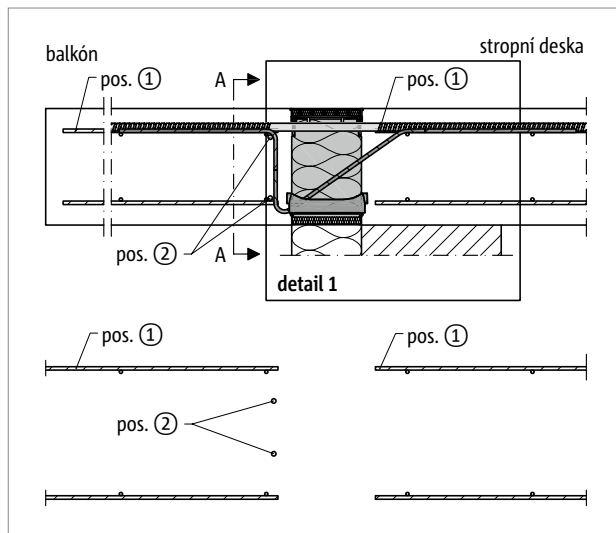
Schöck Isokorb® CXT typ KL-M7-VV1: Půdorys prvku
